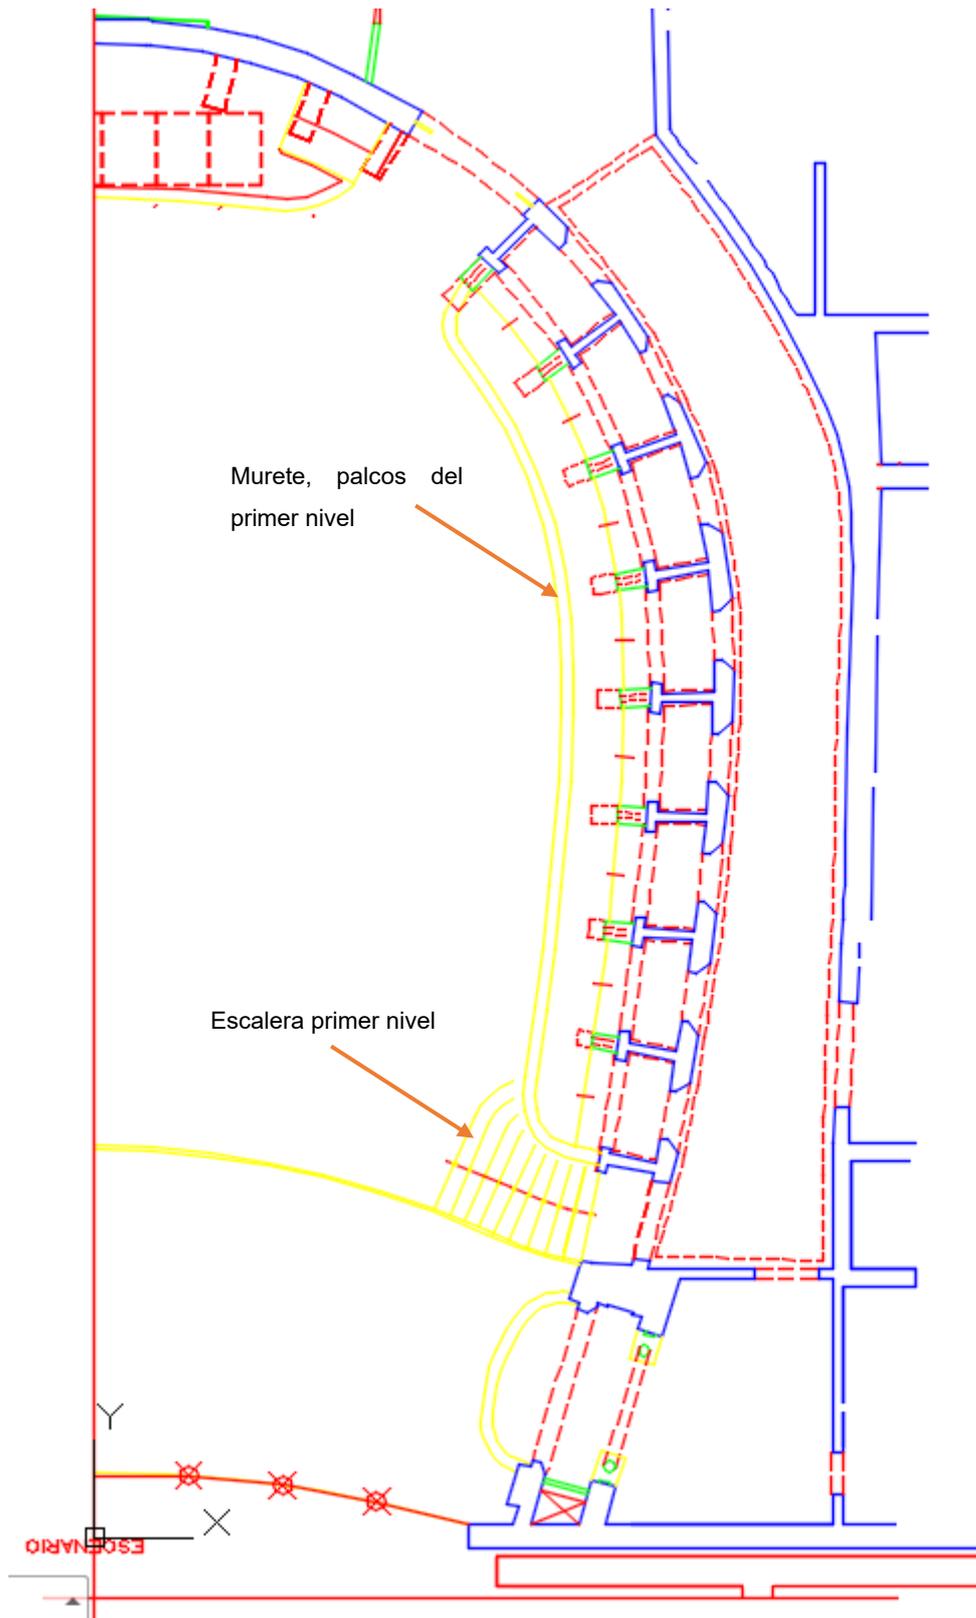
Planta de arquitectura mostrando escalera y murete de palcos primer nivel. (Elaboración propia)
